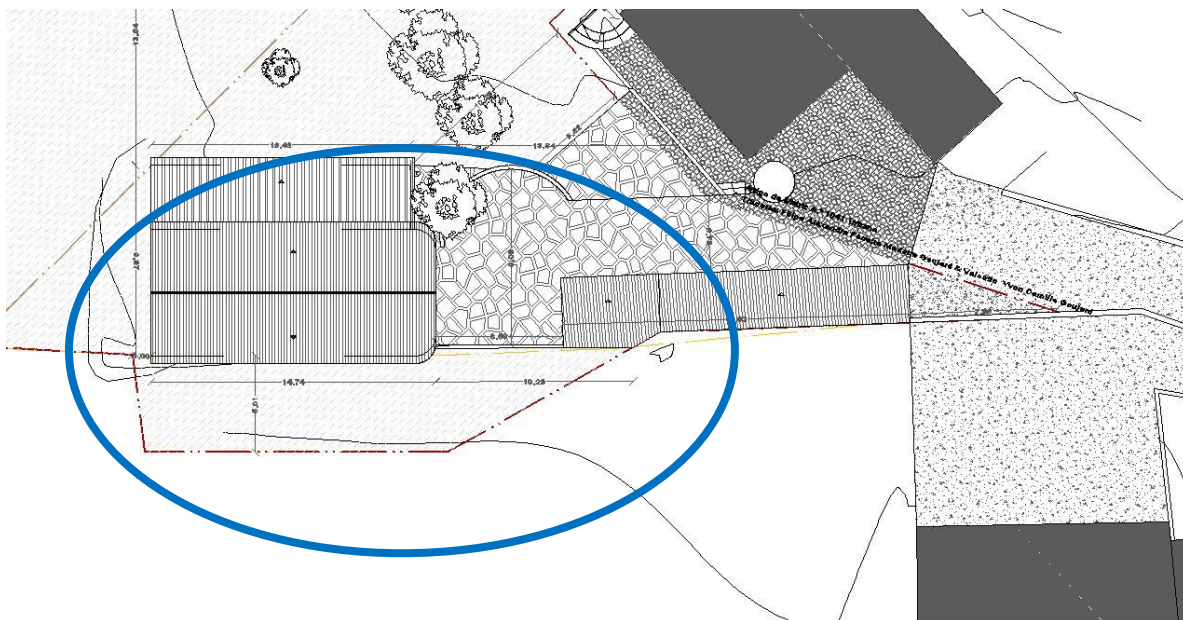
Limite da propriedade apresentado pelo interessado, extraído da planta de implantação entregue (s/ escala).
